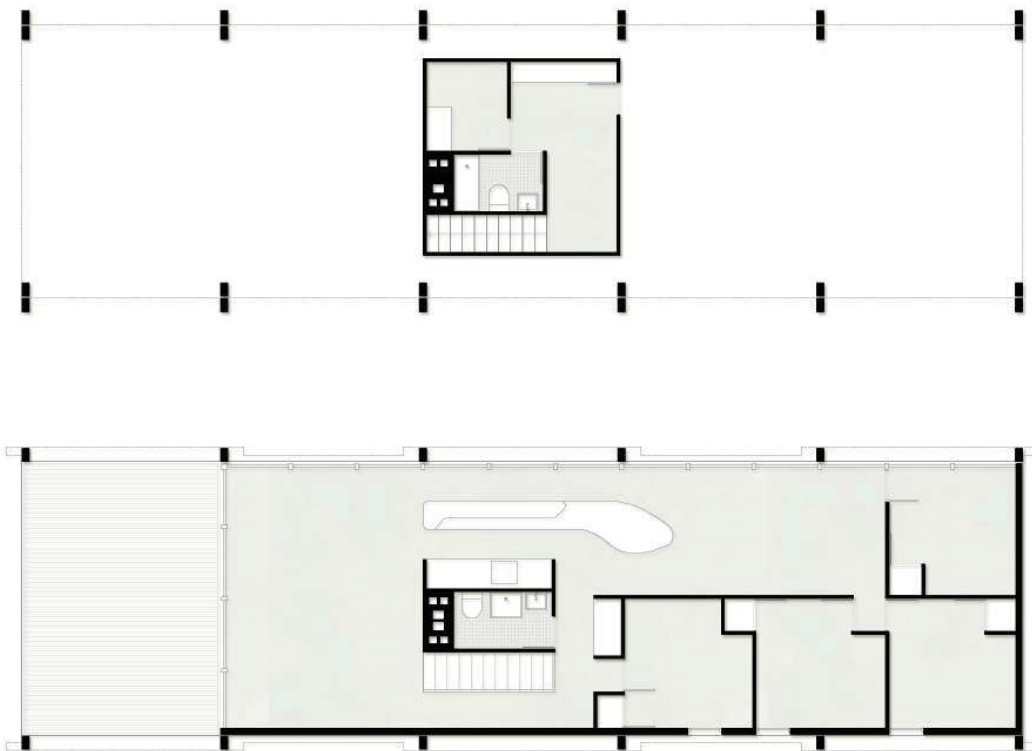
Figura de autor. Planta baja y primera casa Middelboe.
